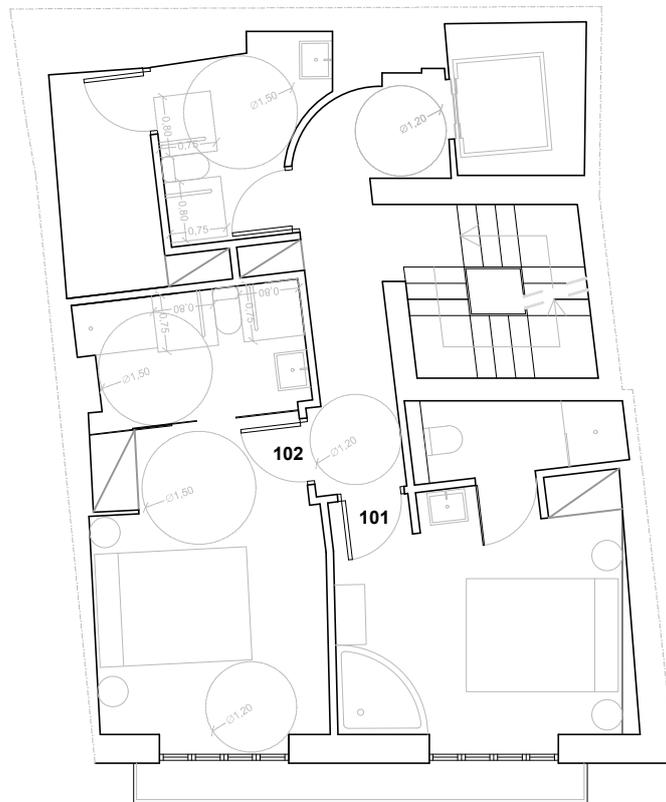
Planta Primera Edificio Propuesta, Fuente: Elaboración Propia
